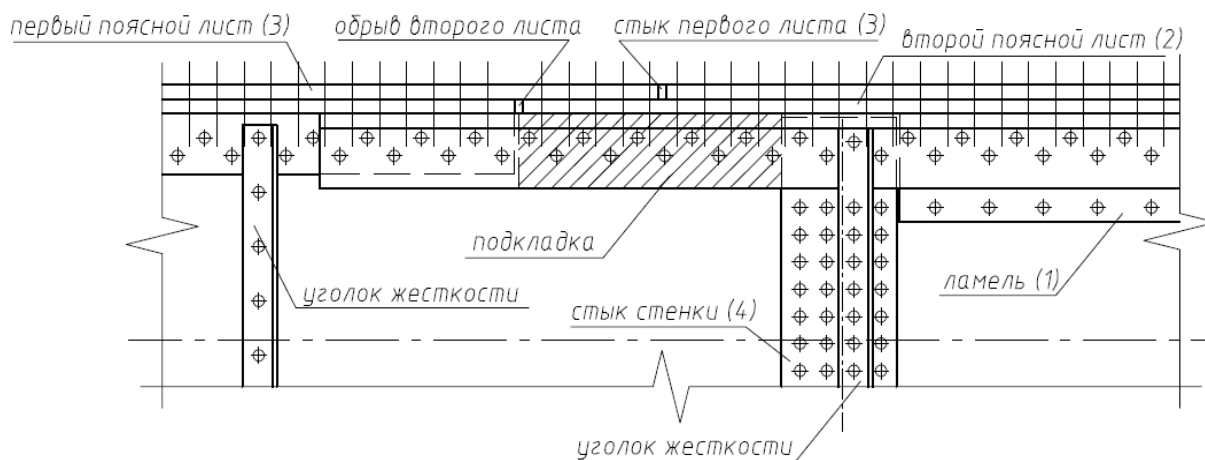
Монтажный стык тяжелой подкрановой балки с ламелями
